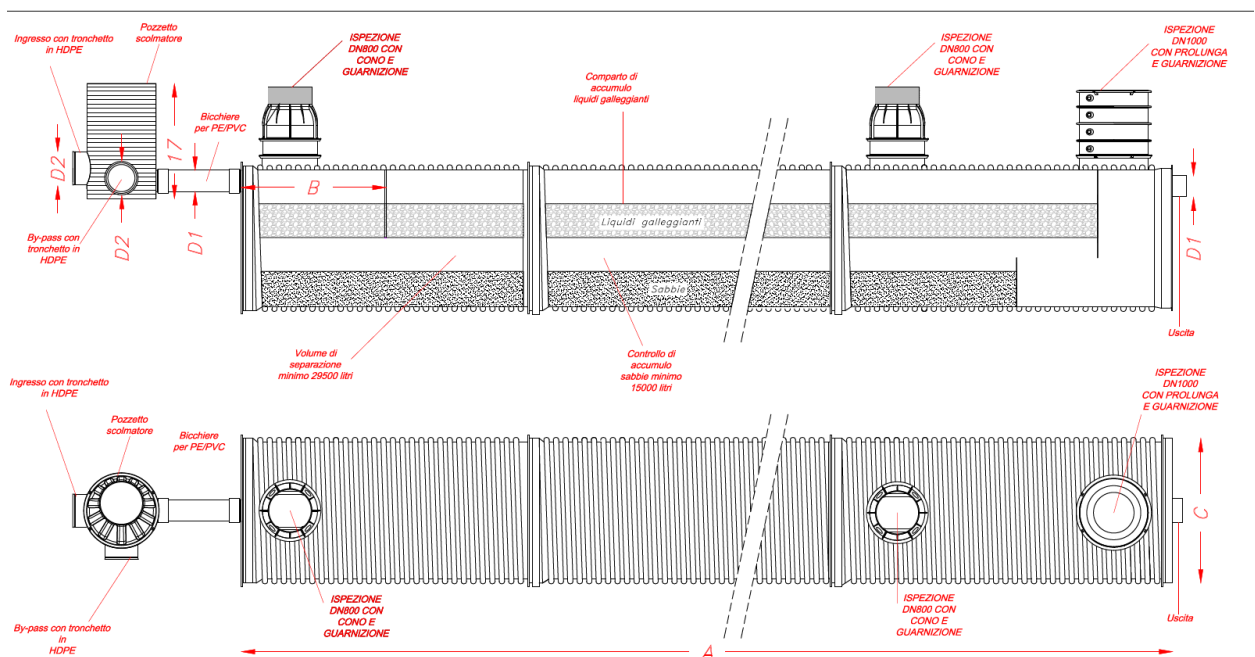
Pianta e sezione degli impianti per la sedimentazione e la disoleazione
